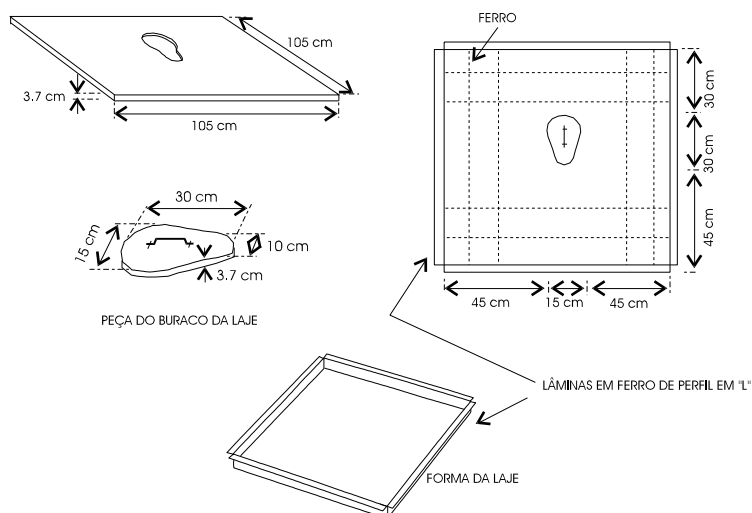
LAJE DE CONCRETO PARA PISO DE PRIVADA
